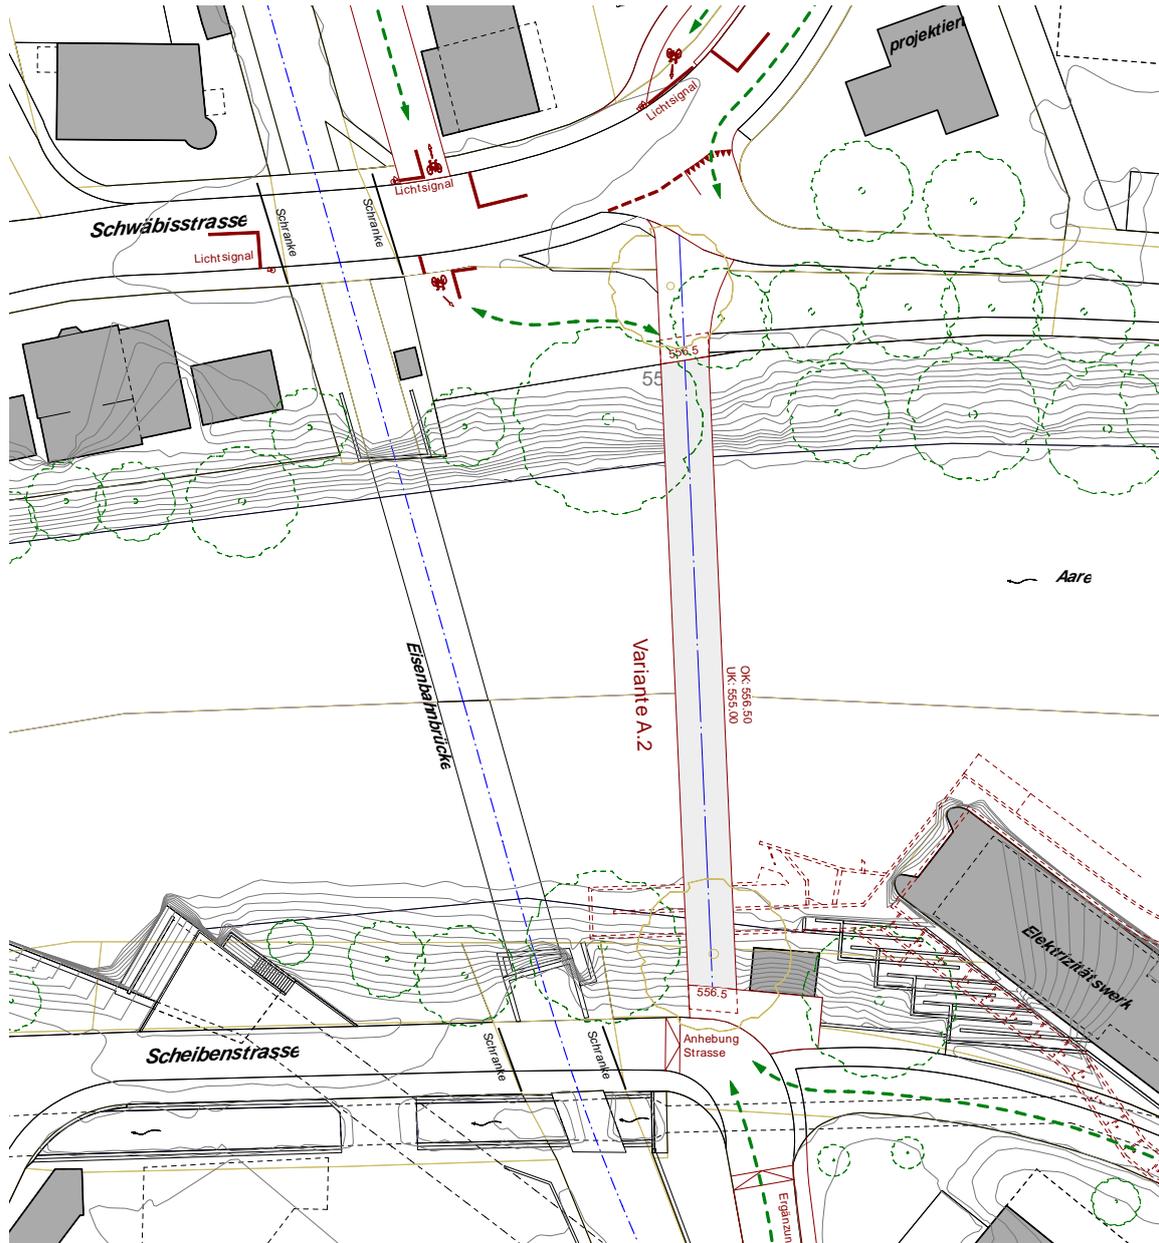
Variante A.2, Plan genordet, o. Massstab (A3-Plan im Anhang)
